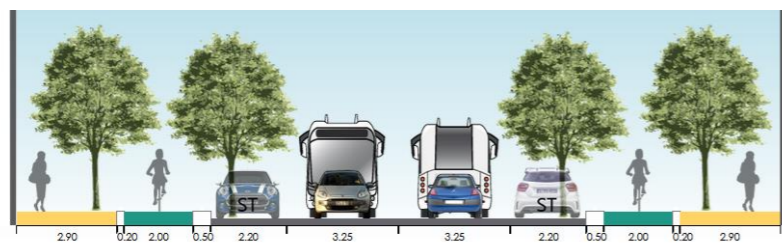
Exemple de section sans site propre BBM – voie mixte (Source : Egis, 2023)
